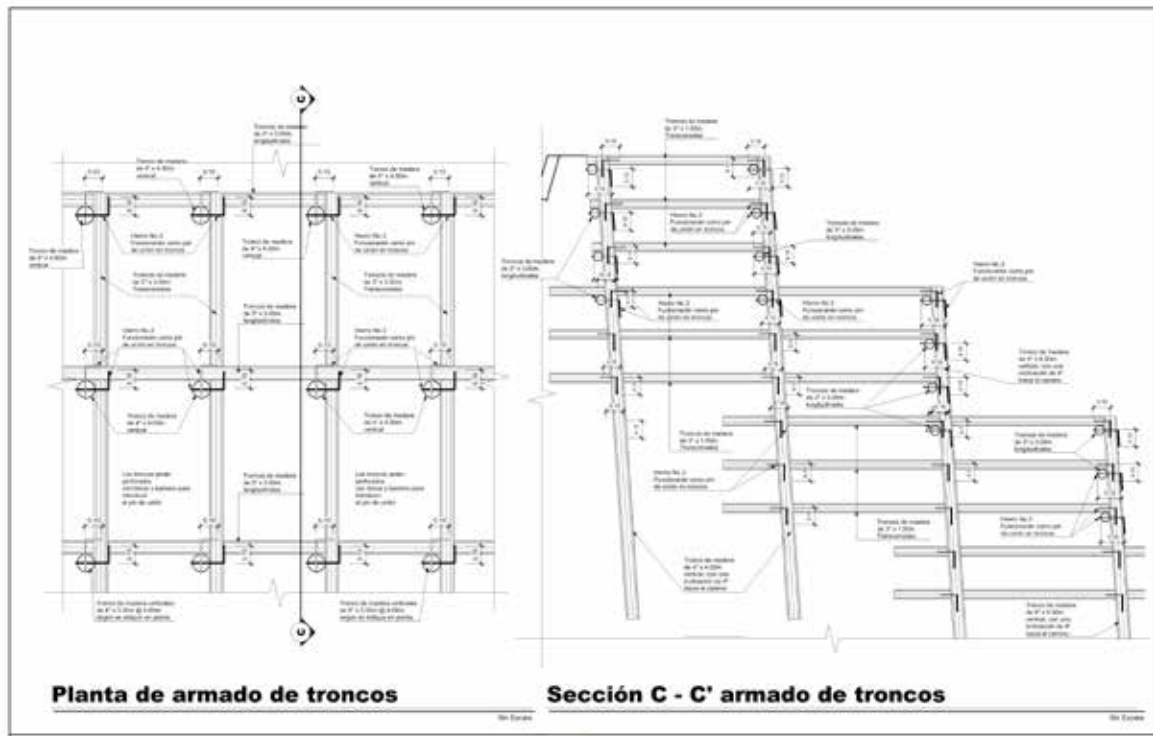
Planta armado troncos. Sección C-C'. Planificación Obra ORCC-03/RD-SOL-08.
